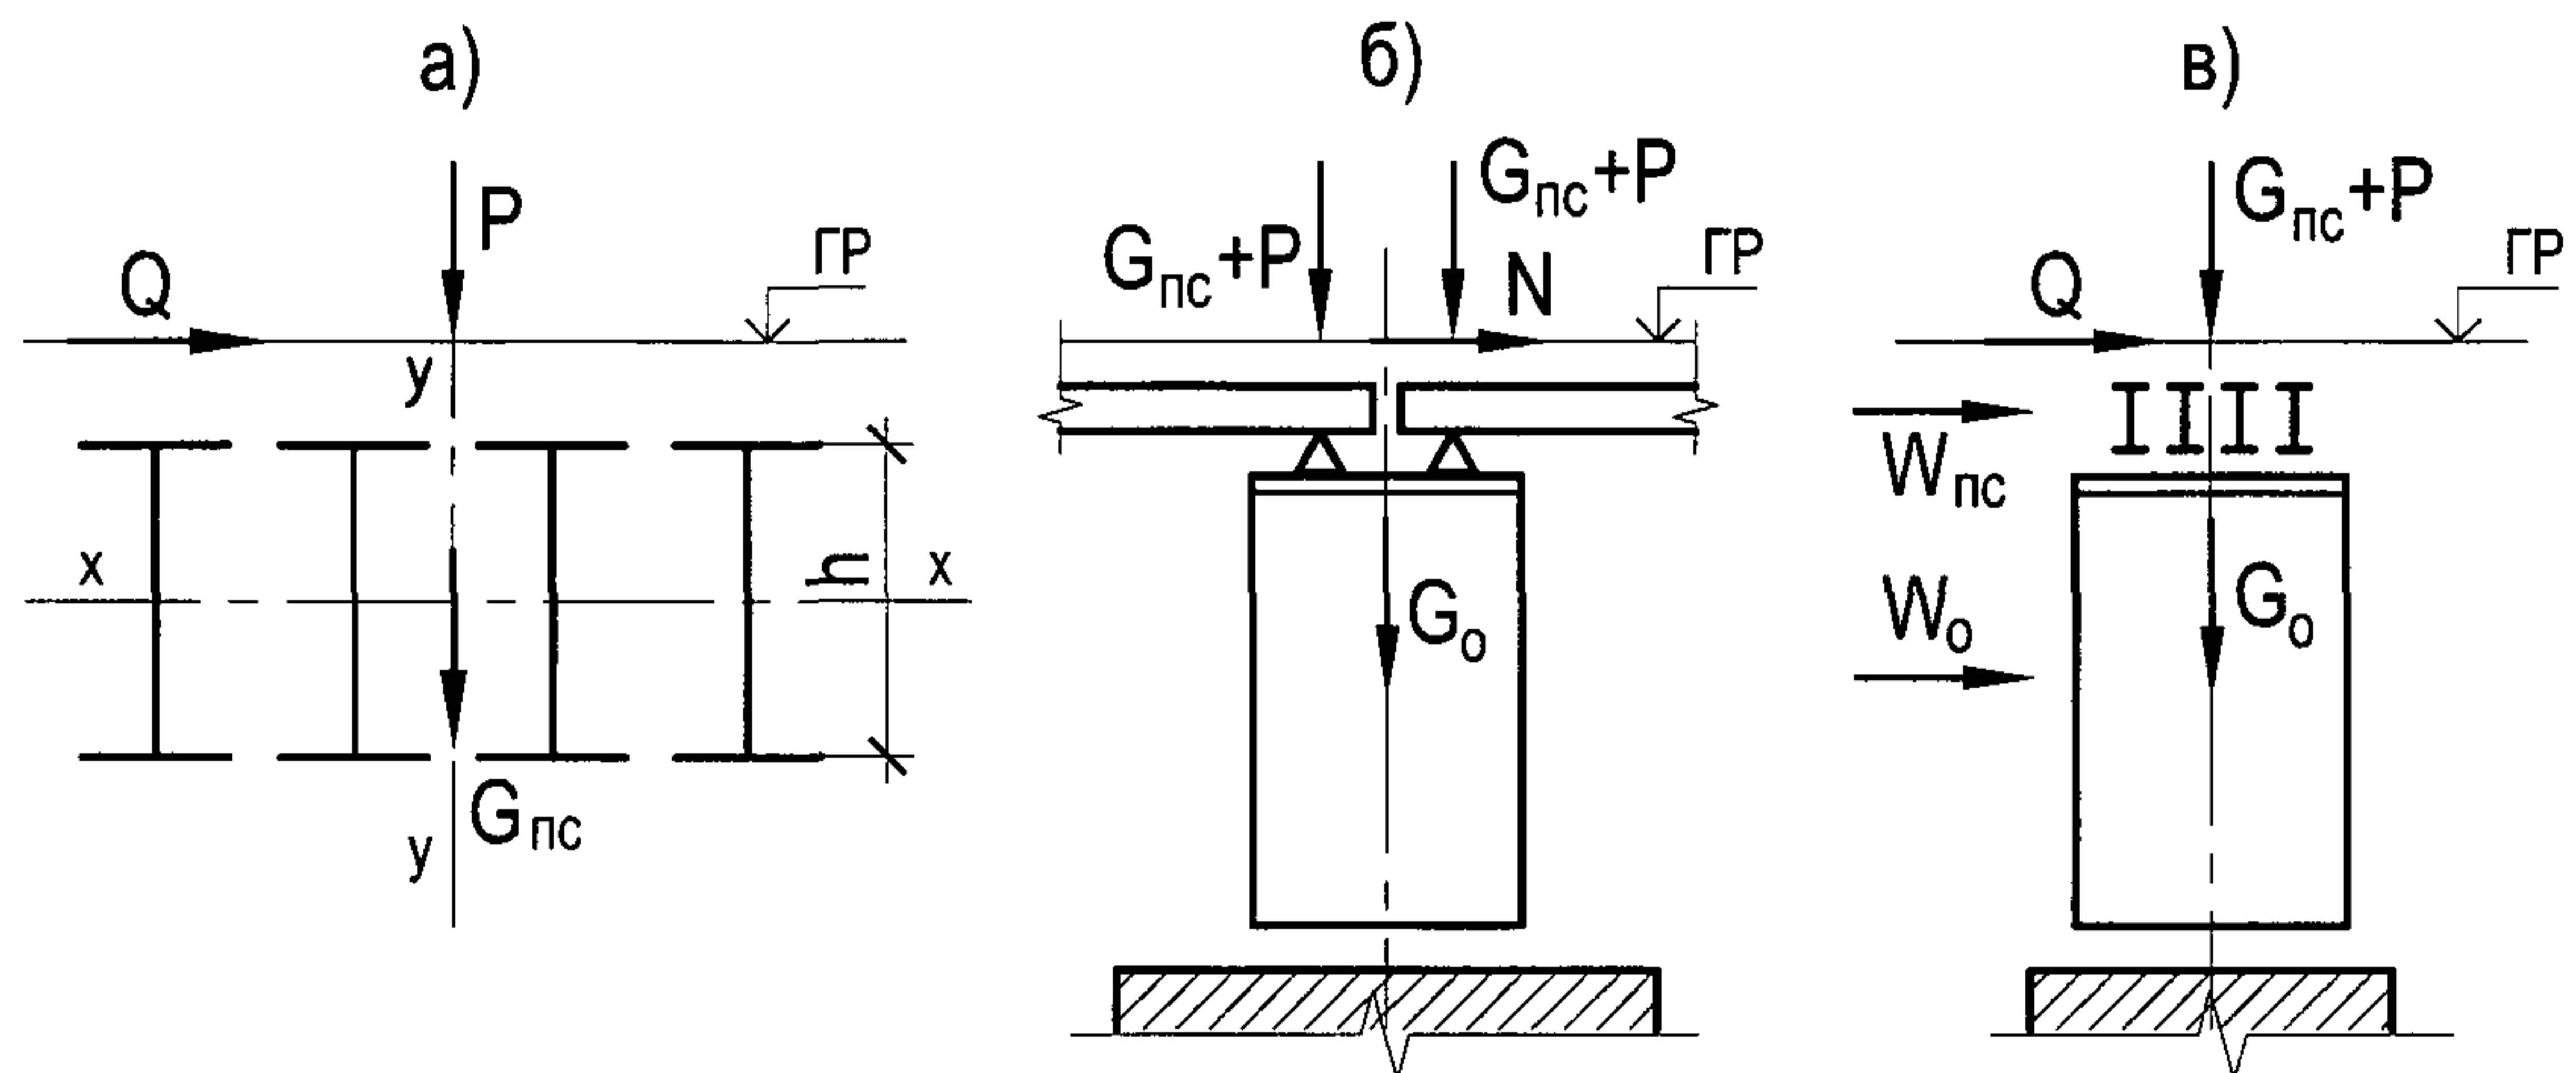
Схемы приложения нагрузок в подкрановых эстакадах
